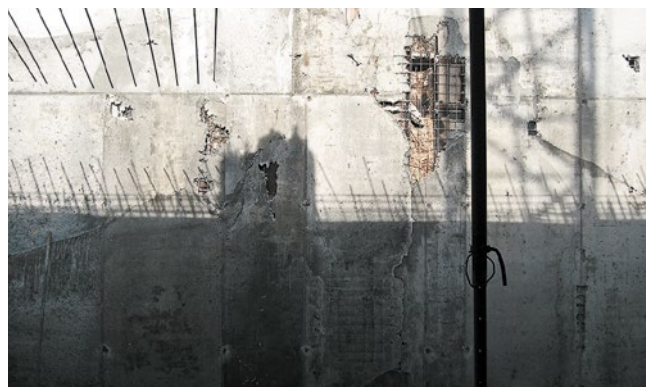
Данная железобетонная конструкция непригодна для укладки гидроизоляционных материалов
